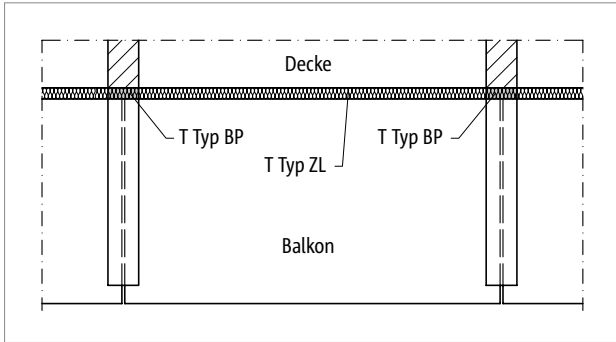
Schöck Isokorb® T Typ BP: Balkonkonstruktion mit frei auskragenden Unterzügen (Fertigteilbalkon)
